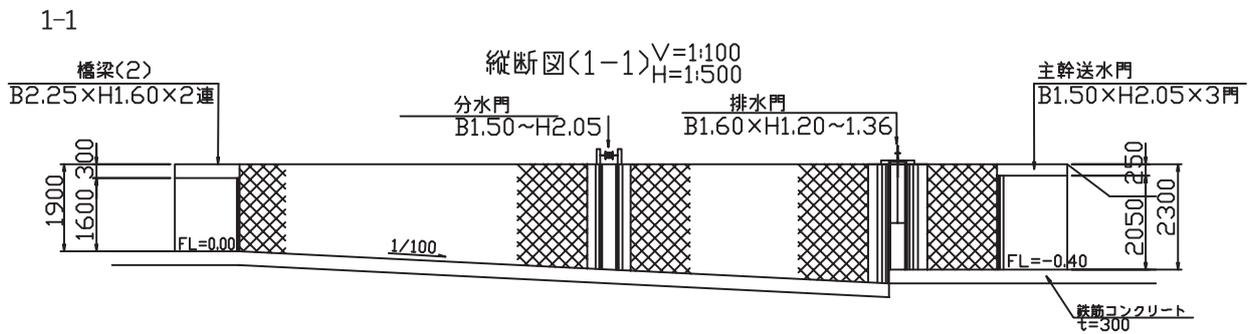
沈砂池縦断面図の例<sup>3)</sup>
